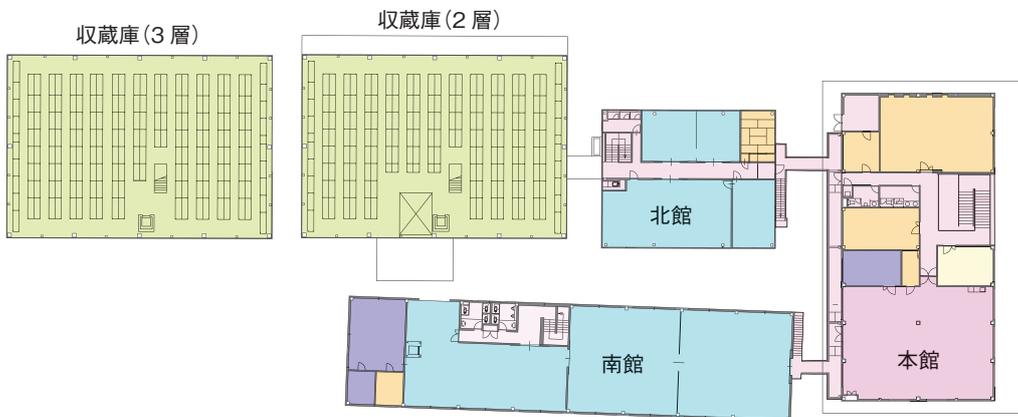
高知県埋蔵文化財センター 2F 平面図(S=1/800)
